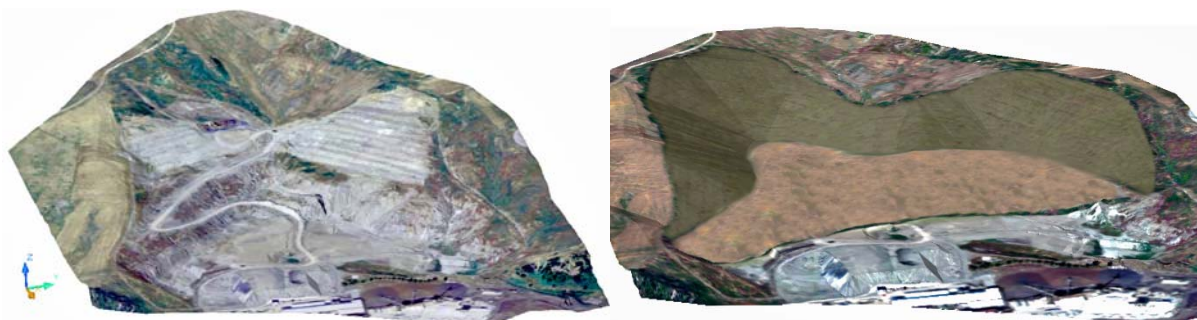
Vista tridimensionale dello stato attuale (a sinistra) e dello stato di progetto (a destra).
